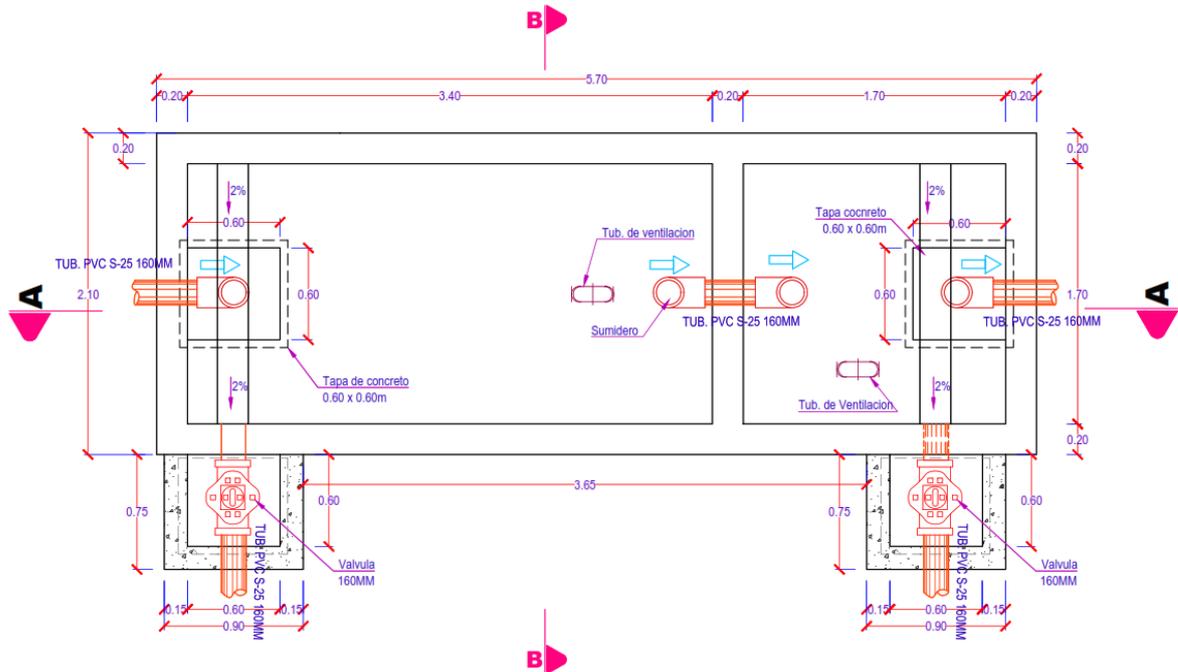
Planta de TANQUE SEPTICO – La Tranca
